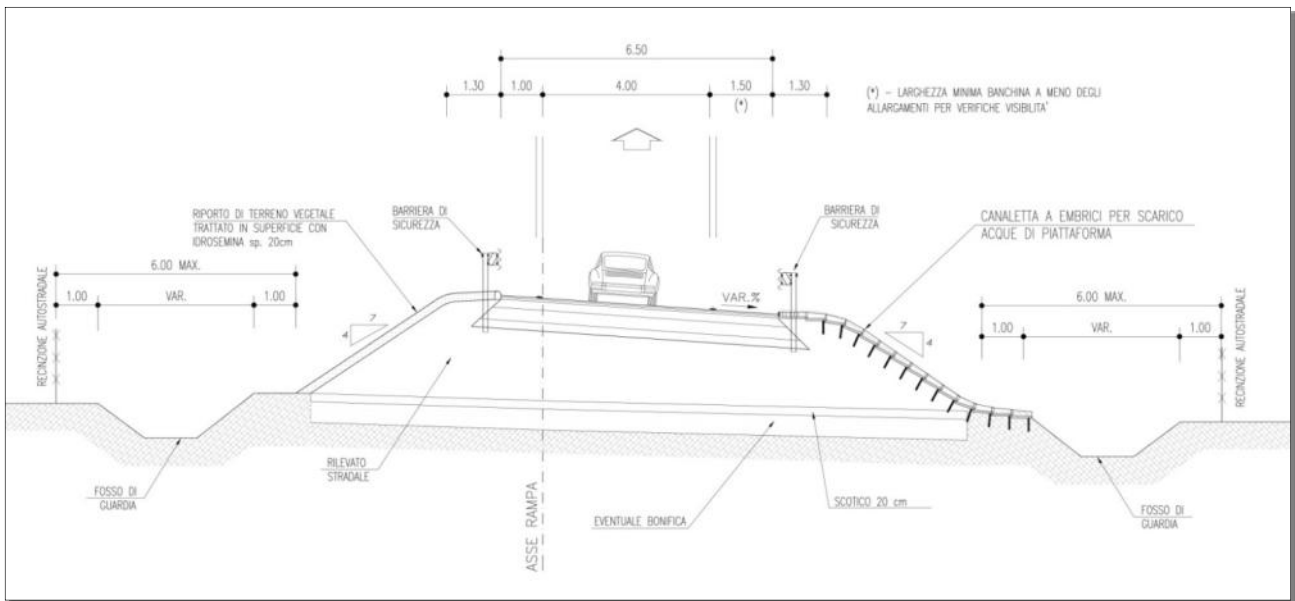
Sezione tipo – Rampa di svincolo monodirezionale
